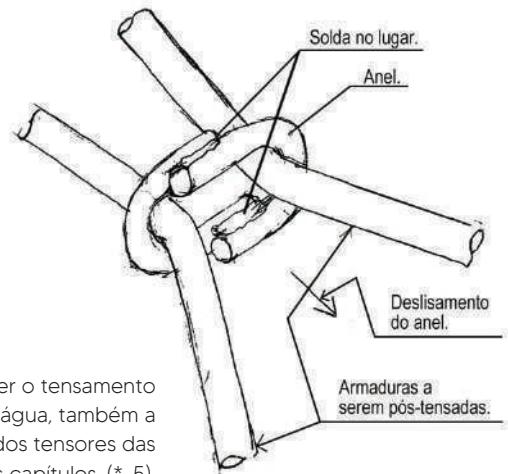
Detalhe do anel para fazer o tensamento das armaduras da caixa d'água, também a solução para o tensamento dos tensores das abóbodas vistas em outros capítulos. (*-5).
